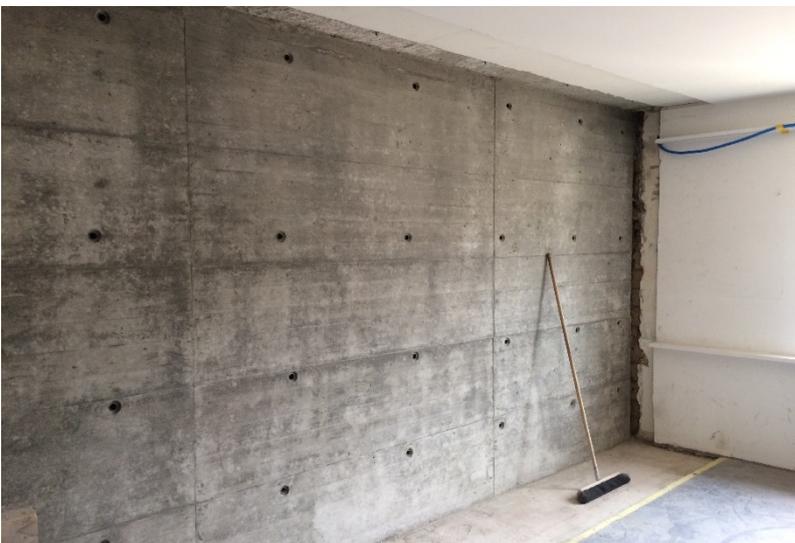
Einbau einer neuen Stahlbetonwand in Gebäudequerrichtung im Erdgeschoss.
